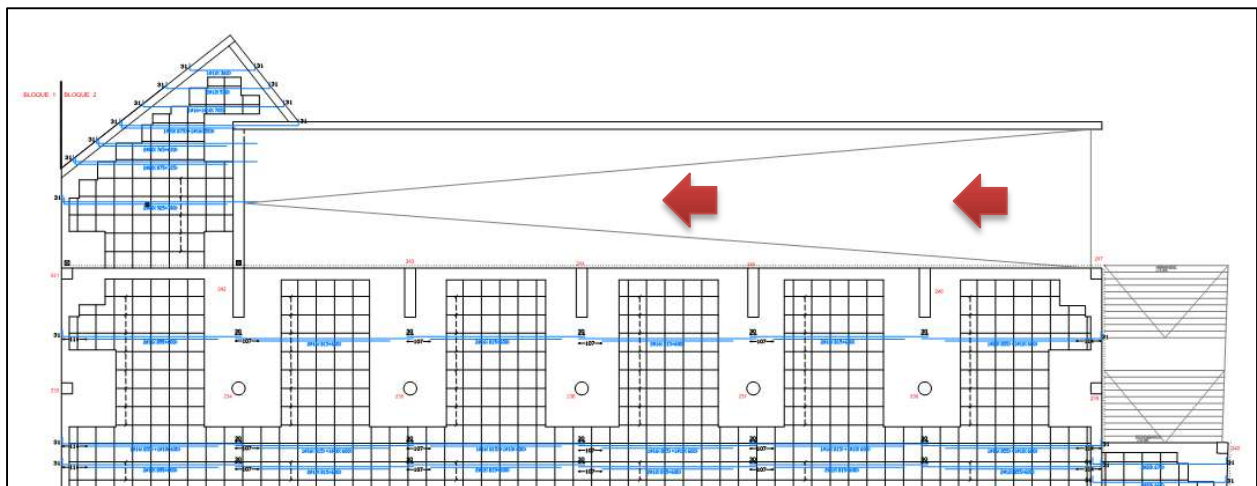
Detalle del plano de armado longitudinal inferior del forjado 3°. La rampa asciende desde el nivel del 2° forjado hasta el 3° como indicamos según la dirección de la flecha
